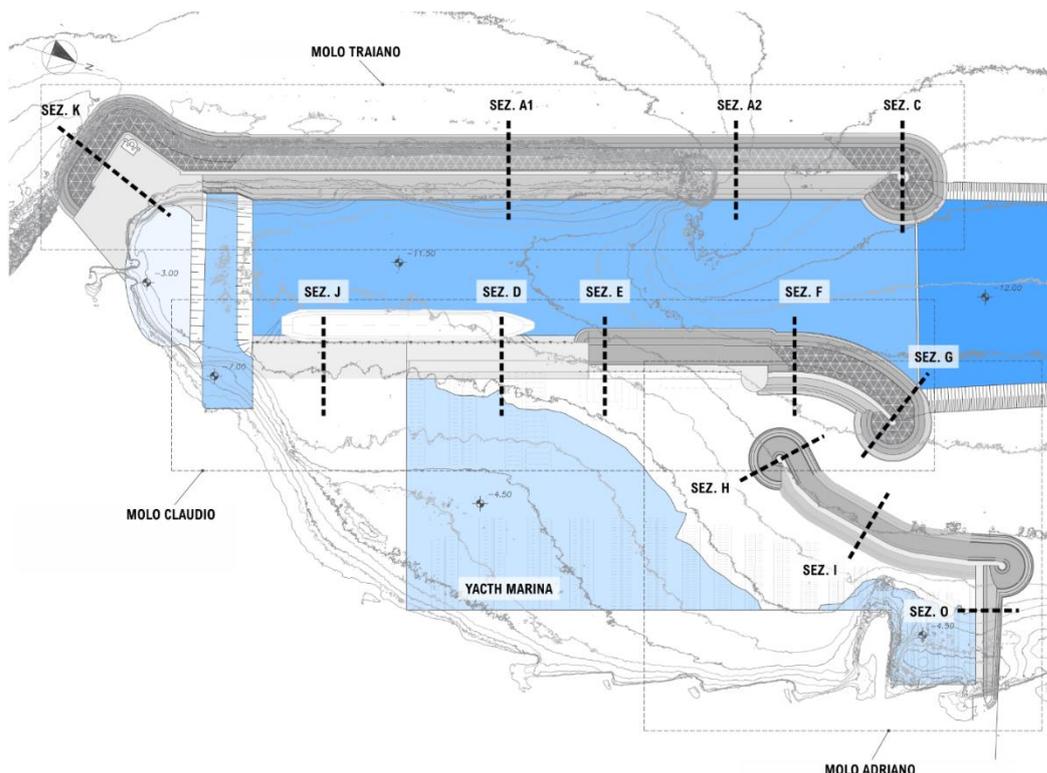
Planimetria di Progetto delle Opere Marittime
